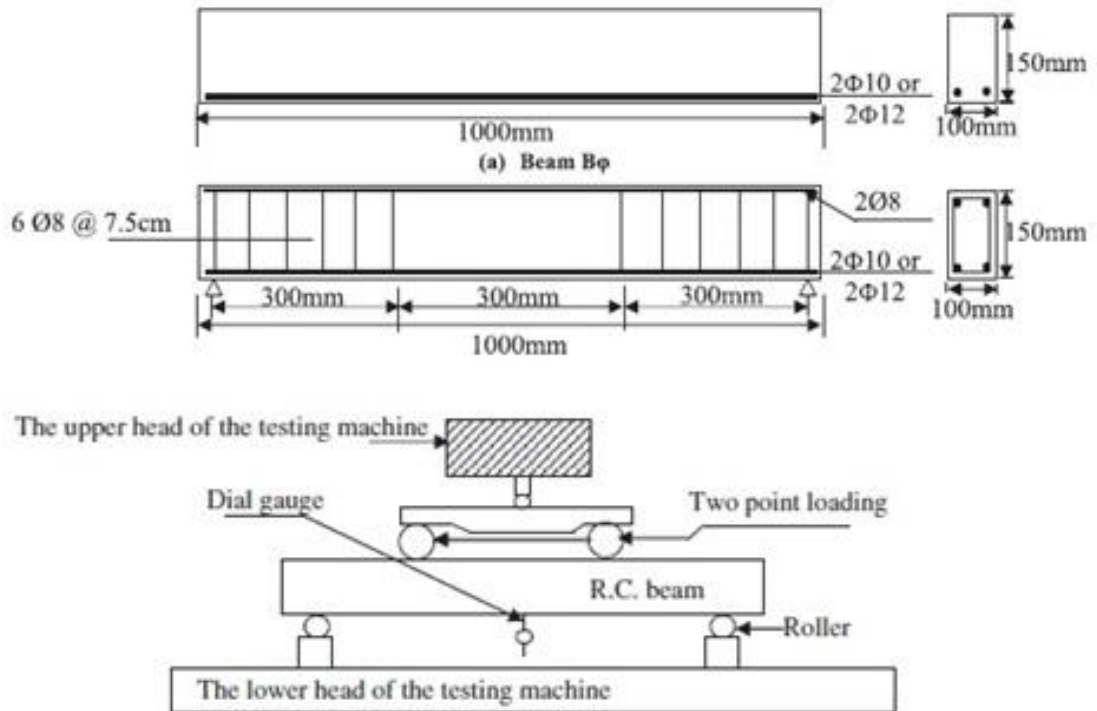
Geometría y distribución de armado de las vigas. Esquema de ensayo y medida, Kamal et al. (2013) [68]
